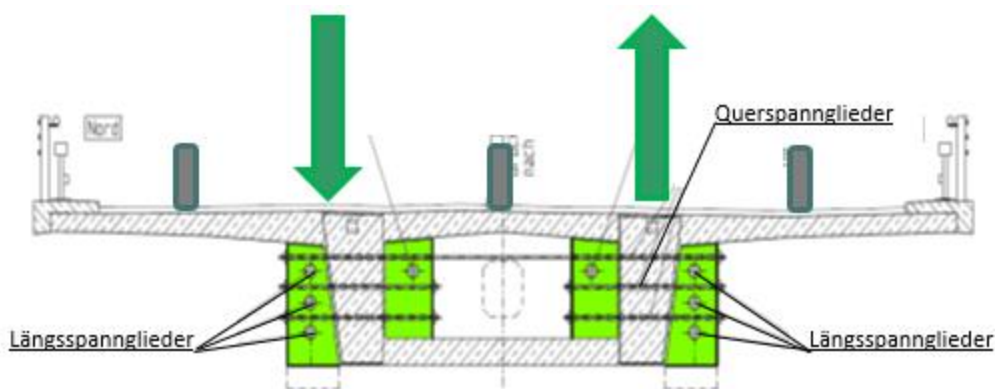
Querschnitt durch die Brücke (grün: Stahlbetonkonsolen) (Quelle: NLSStBV)
